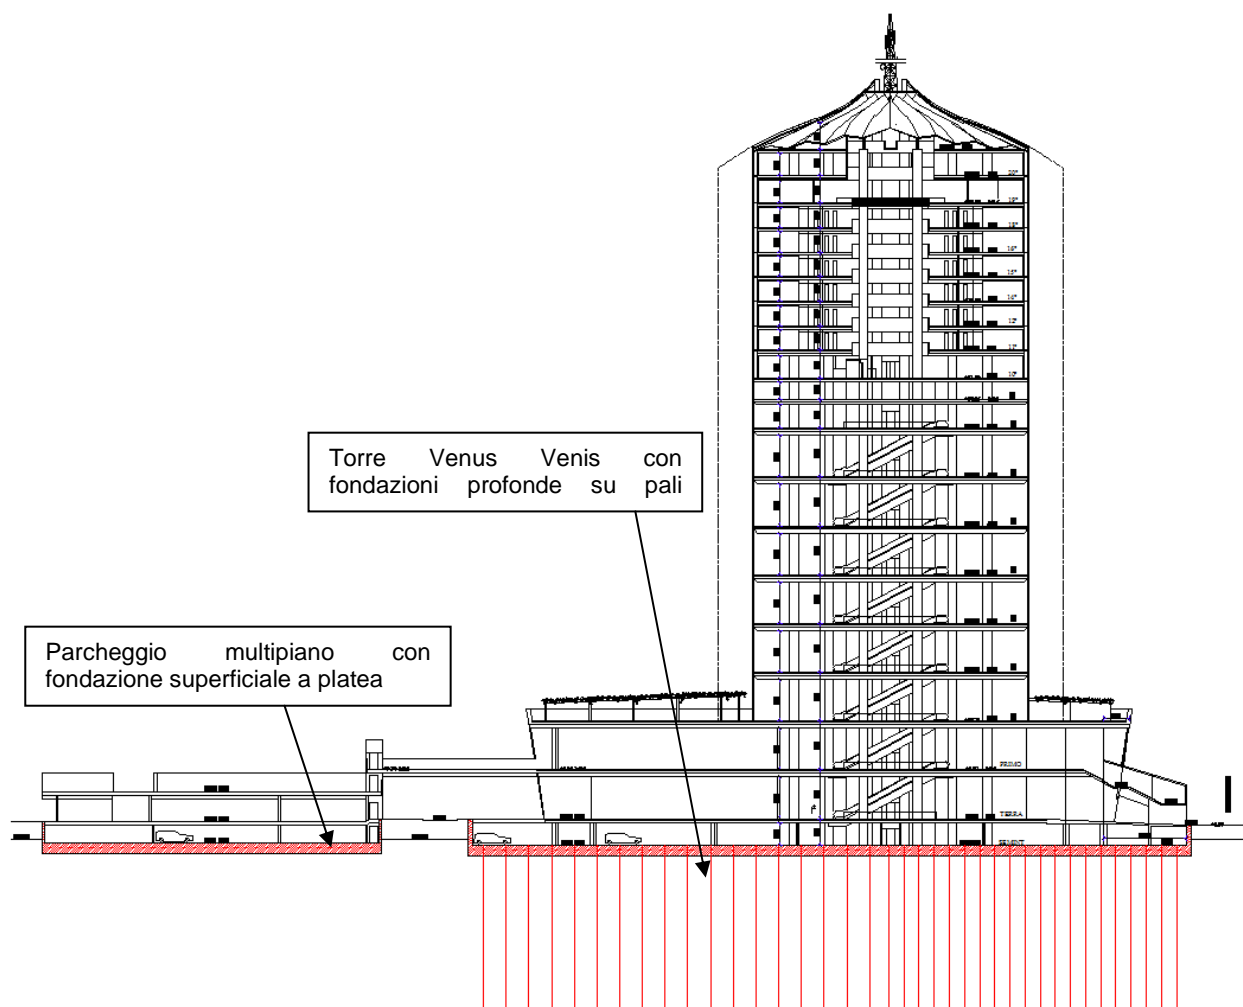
Fondazioni profonde sotto la torre di 17 piani e fondazione superficiale sotto il parcheggio multipiano.
